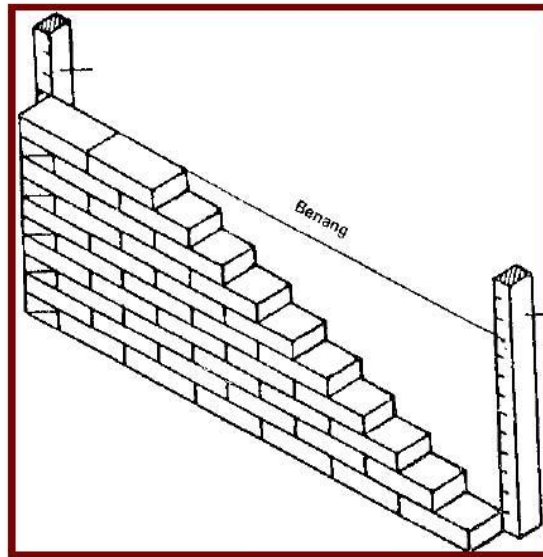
Cara pemasangan batu bata dengan kolom beton
